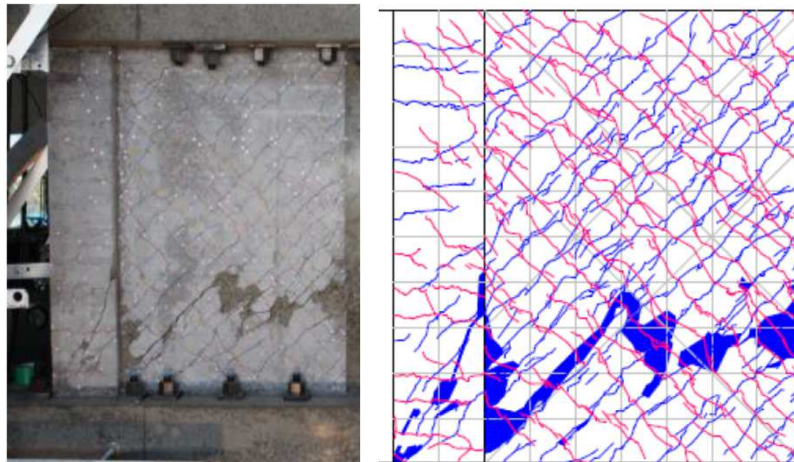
試験体S-D0 最終破壊時写真・ひび割れ図
